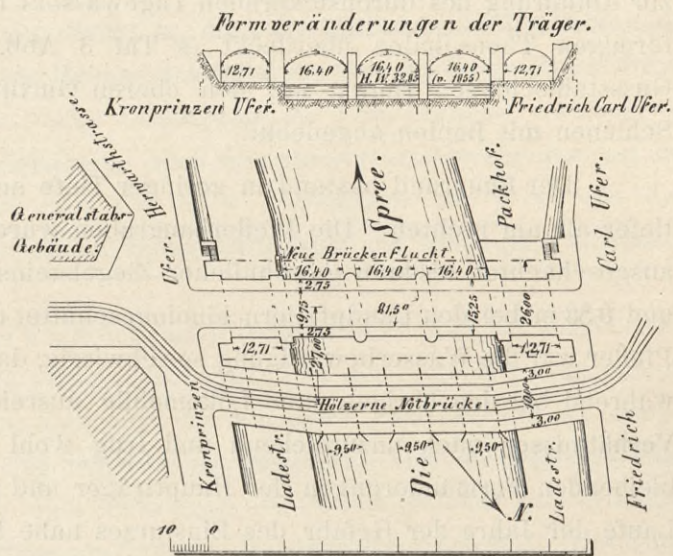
u. 43. Formänderungs- und Lageplan der Unterspree-Brücke.
